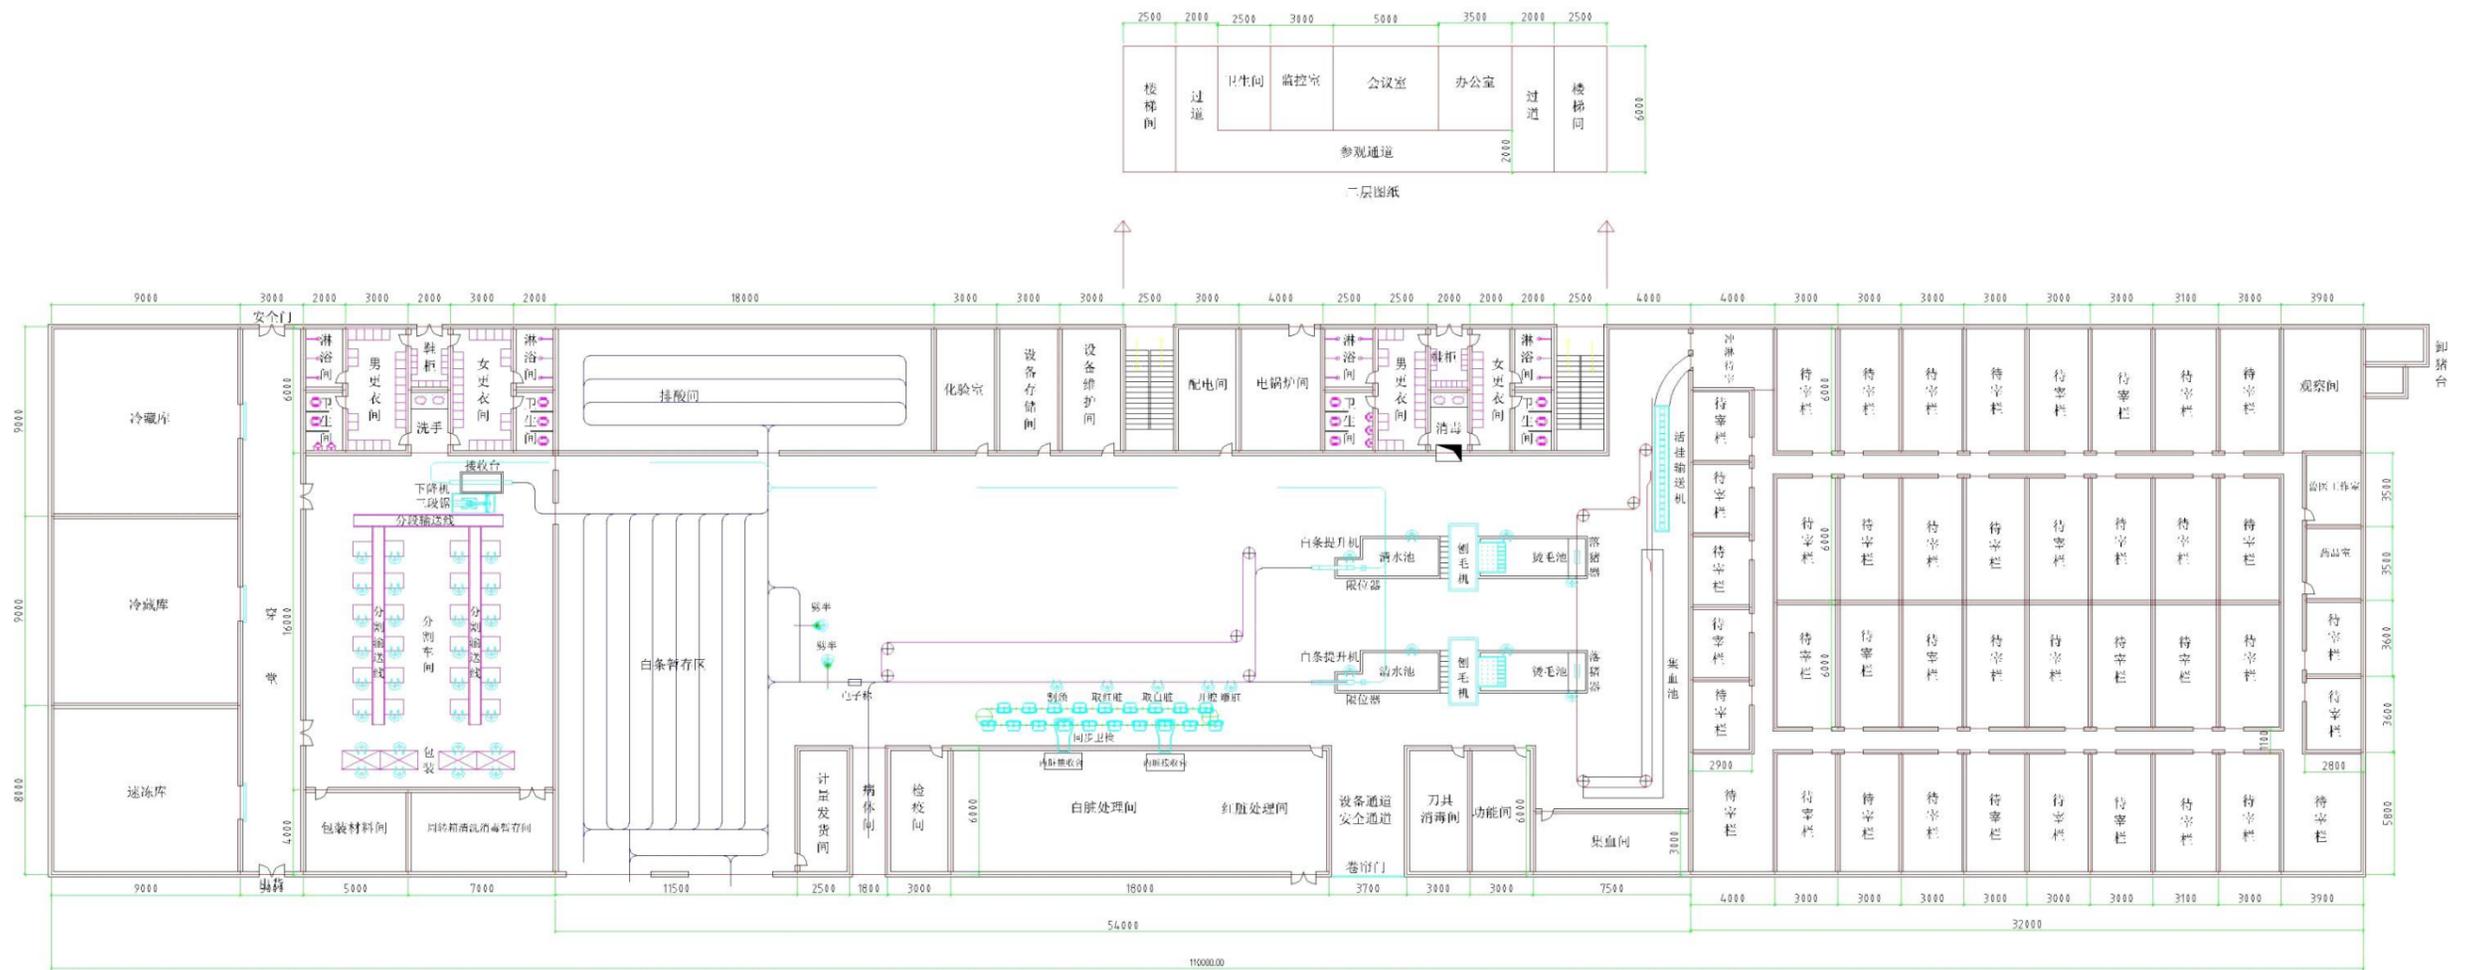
1#车间（生猪屠宰加工车间）平面布置图
